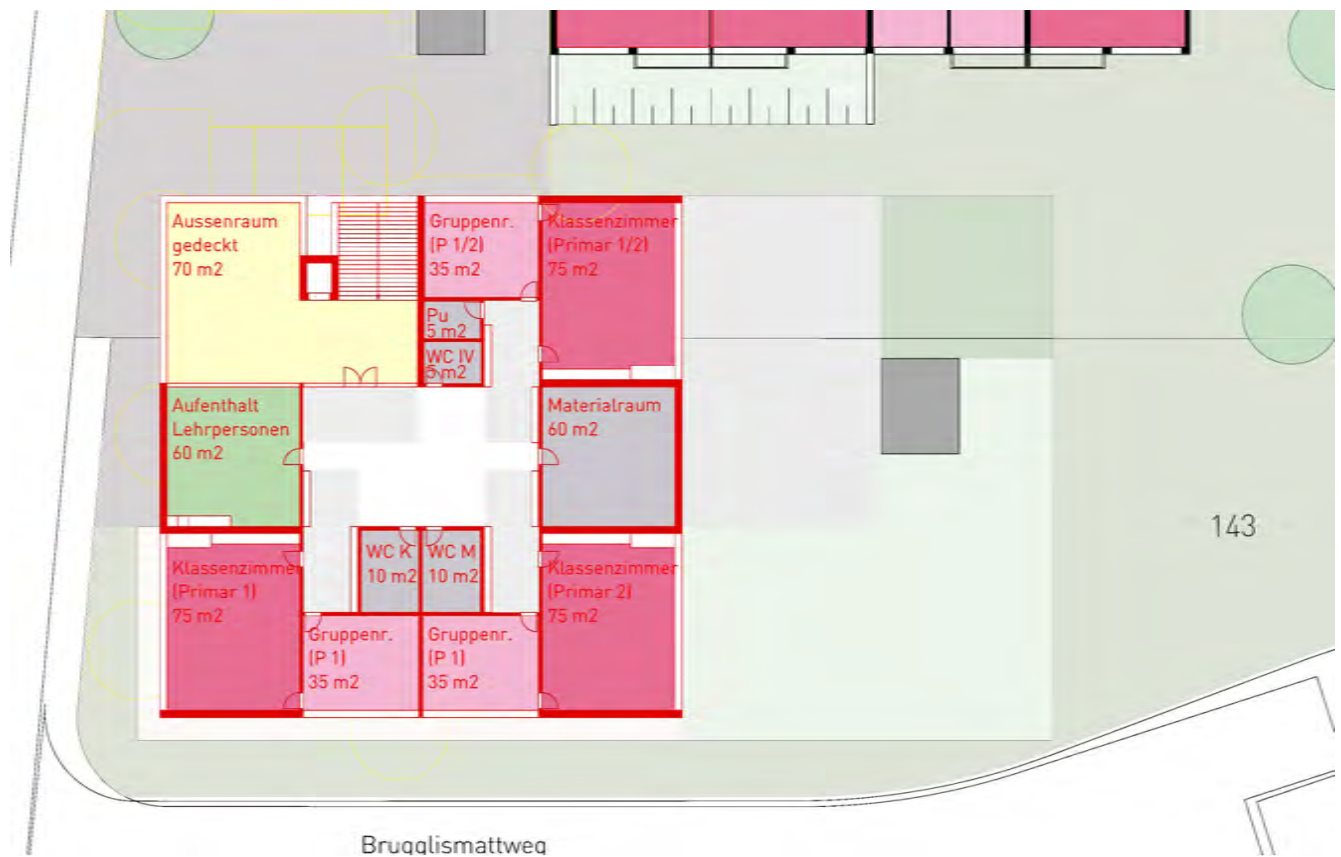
Grundriss, 1./2. Klasse im 1. Obergeschoss
